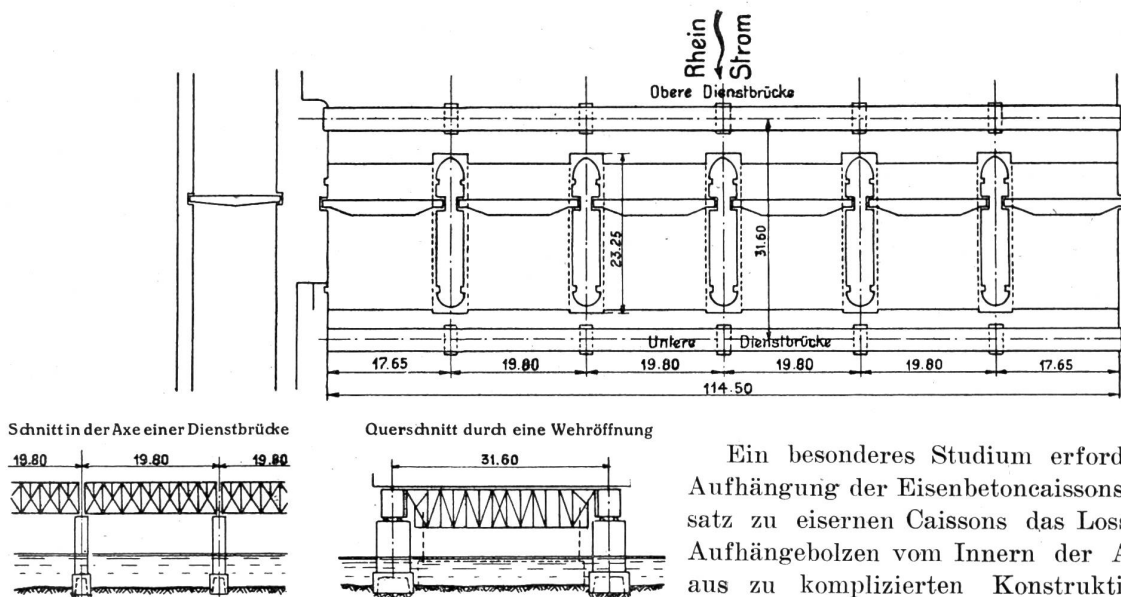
Grundriss und Schnitte des Stauwehrs.
